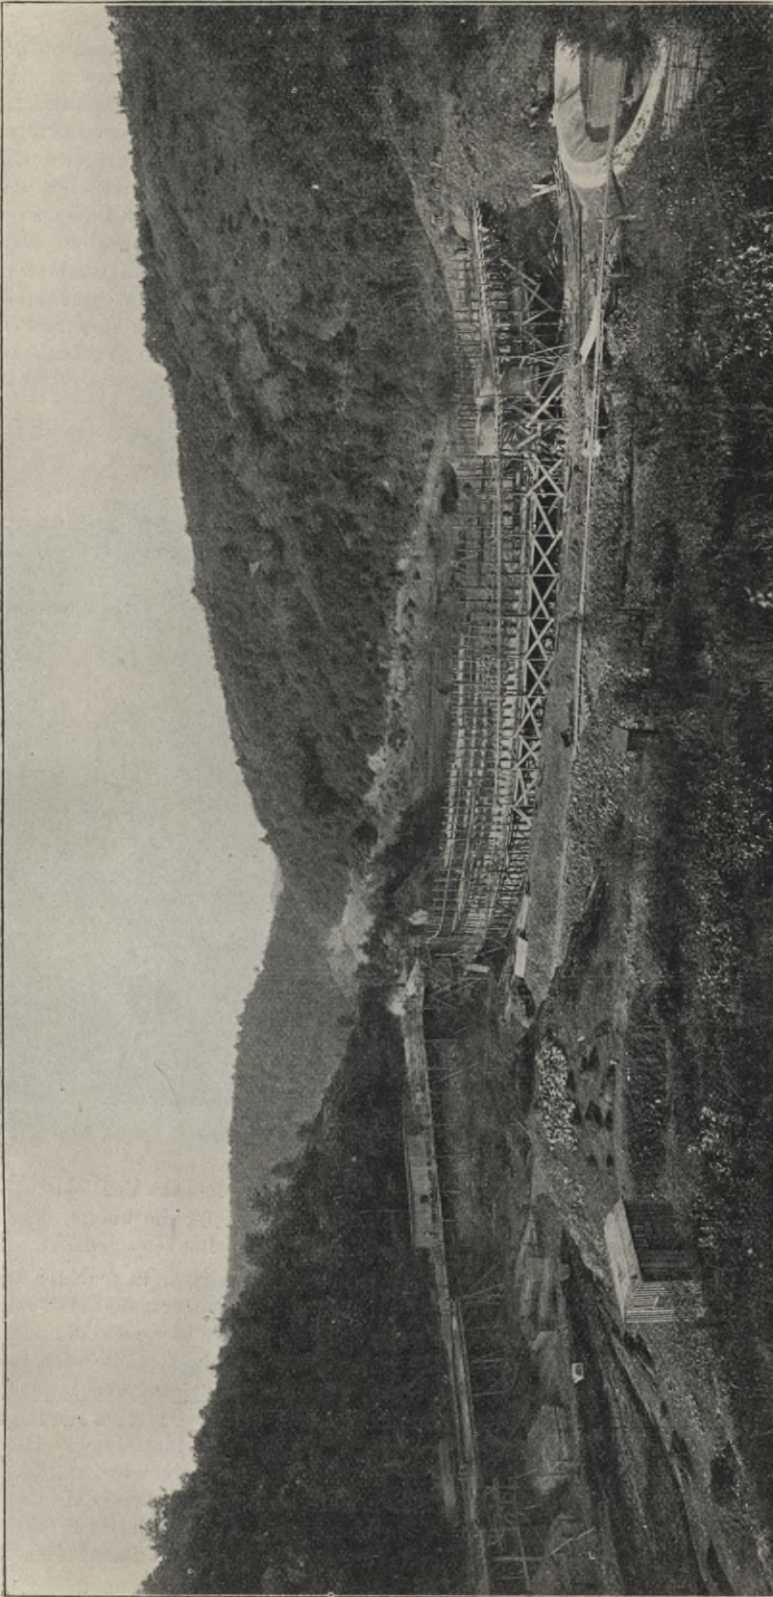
Ausführung des Betonkerns im Solinger Staudamm.
